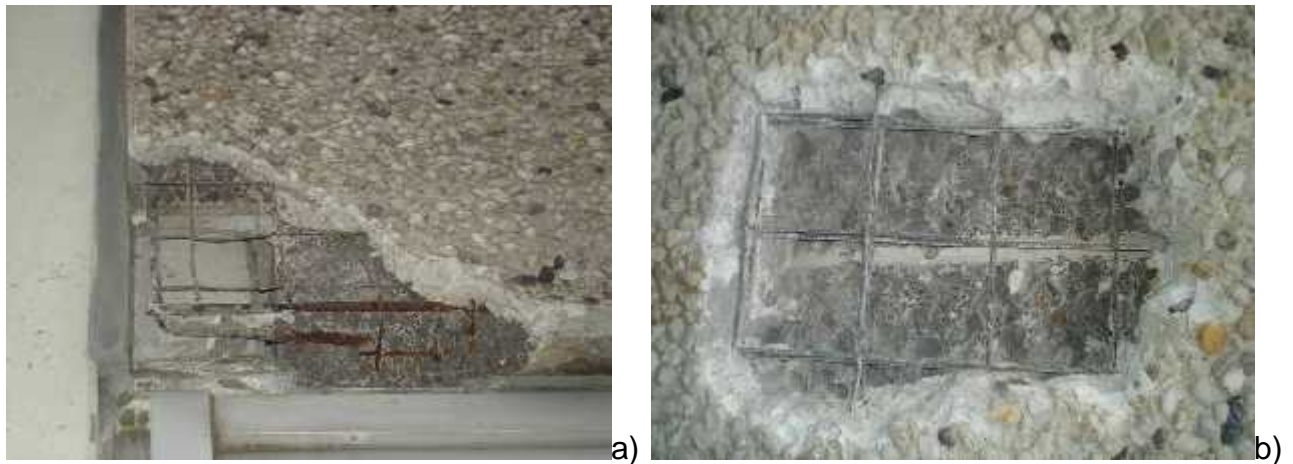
Verbundbauweise aus Normalwaschbetonaußenseite und Leichtbetoninnenseite der Fassadenbauteile mit sichtbarer Bewehrungsführung und erkennbarem Korrosionszustand a) Konsolenausbildung eines Fertigteils an der Eingangsseite mit korrodierter Betonstahlbewehrung, b) Flächenbewehrung eines Fertigteils oberhalb der Glasfassade an der Schwimmhallenlängsseite Betonstahlbewehrung zeigt hier keine Bewehrungskorrosion
